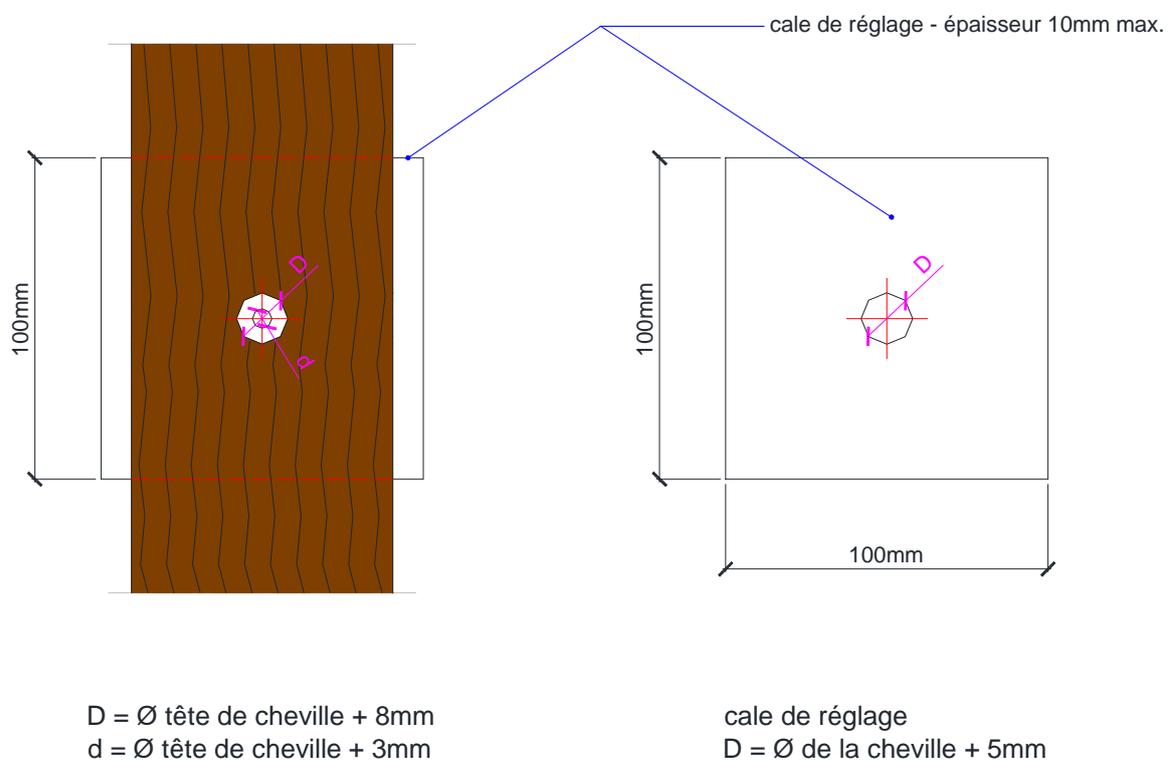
Fixation directe sur le support – Ossature bois – Détail cale de réglage
